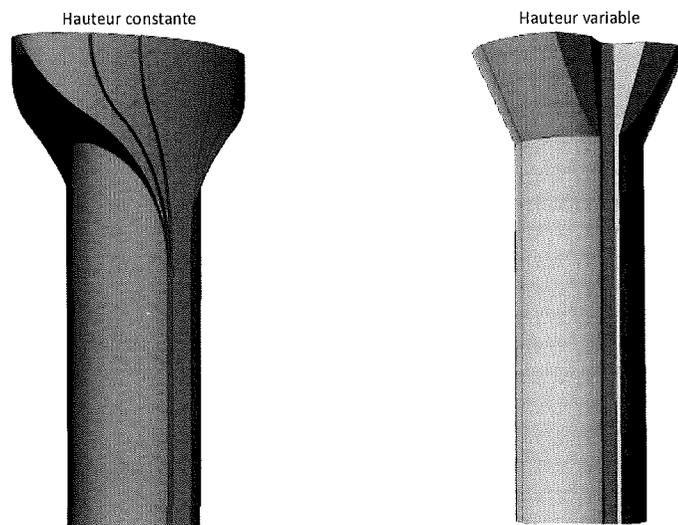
principe architectural des piles (source : Lavigne & Chéron Architectes)
